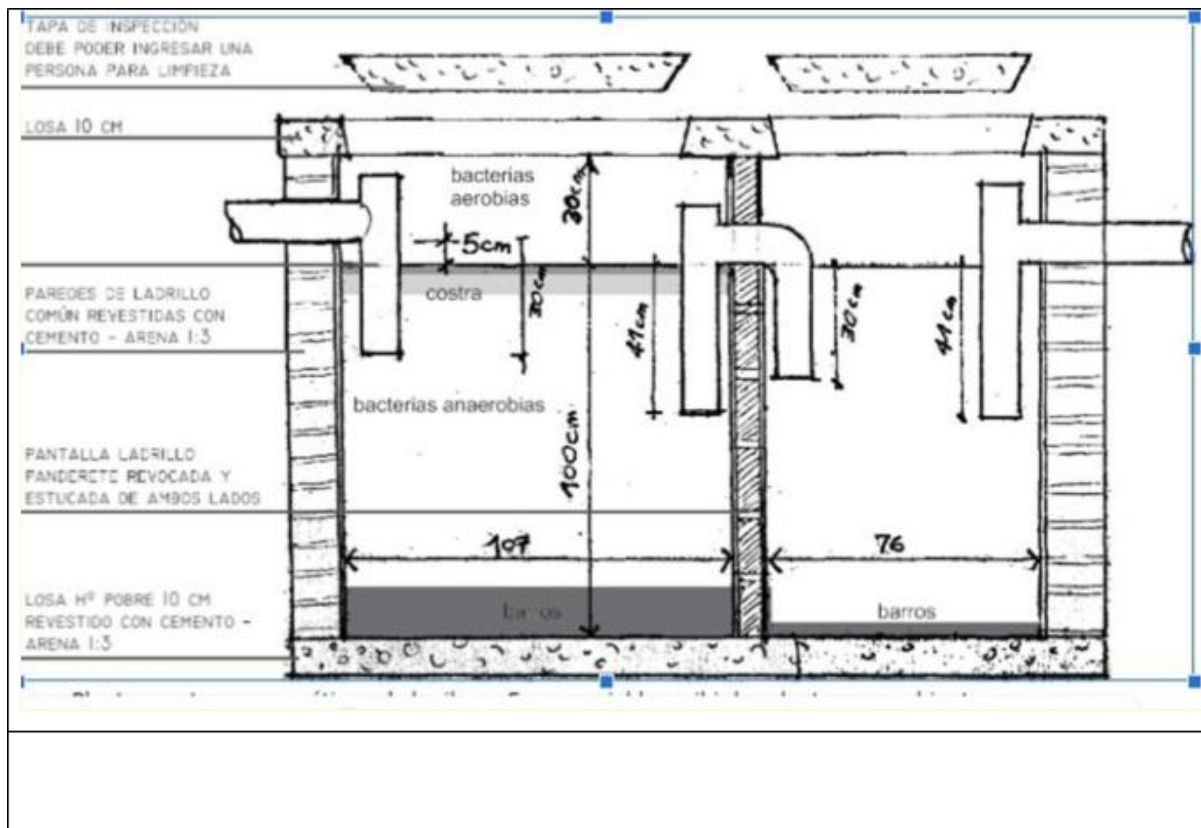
Cámara Séptica – Corte Transversal - Detalles constructivos Fuente: Fundación Proeco San Miguel, Isabel Donato
